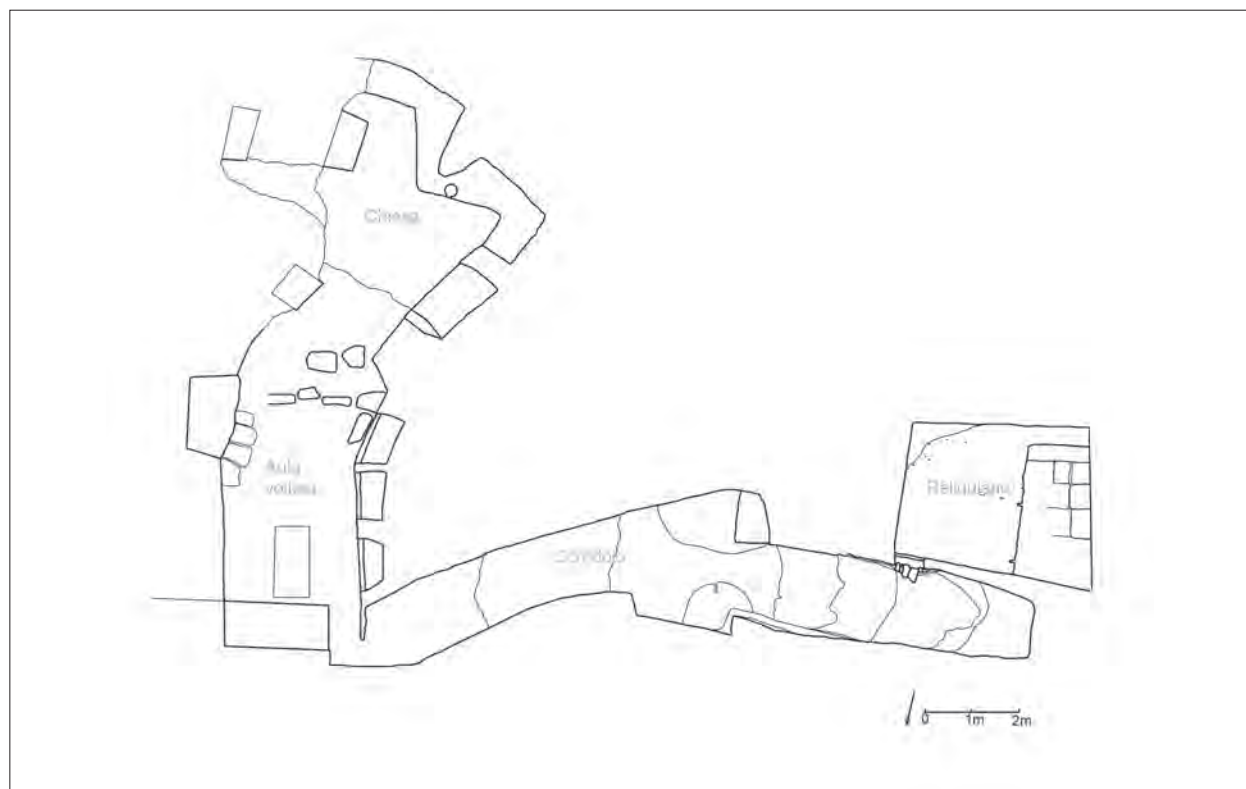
Planimetria del complesso culturale individuato (planimetria e grafica di A. Angelini, F. Giletti, S. Grassi)
